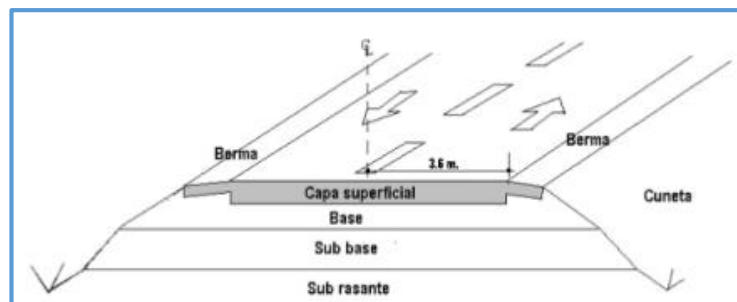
Estructura típica de un pavimento asfáltico (flexible).
